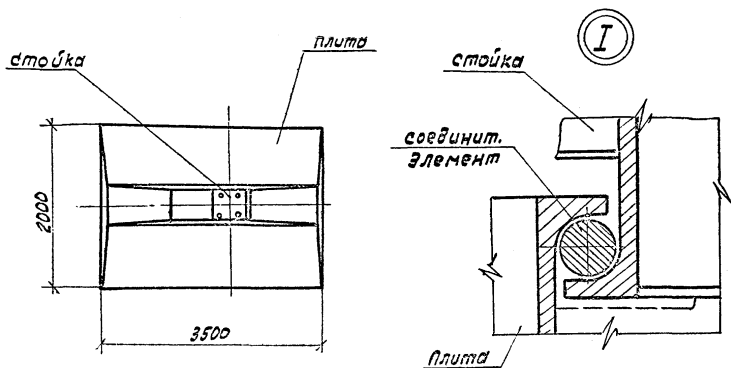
Конструкции унифицированных железобетонных элементов фундаментов
